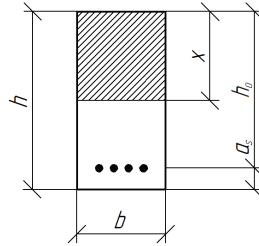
Поперечний переріз балки з параметрами за попередніми будівельними нормами і правилами [4]
